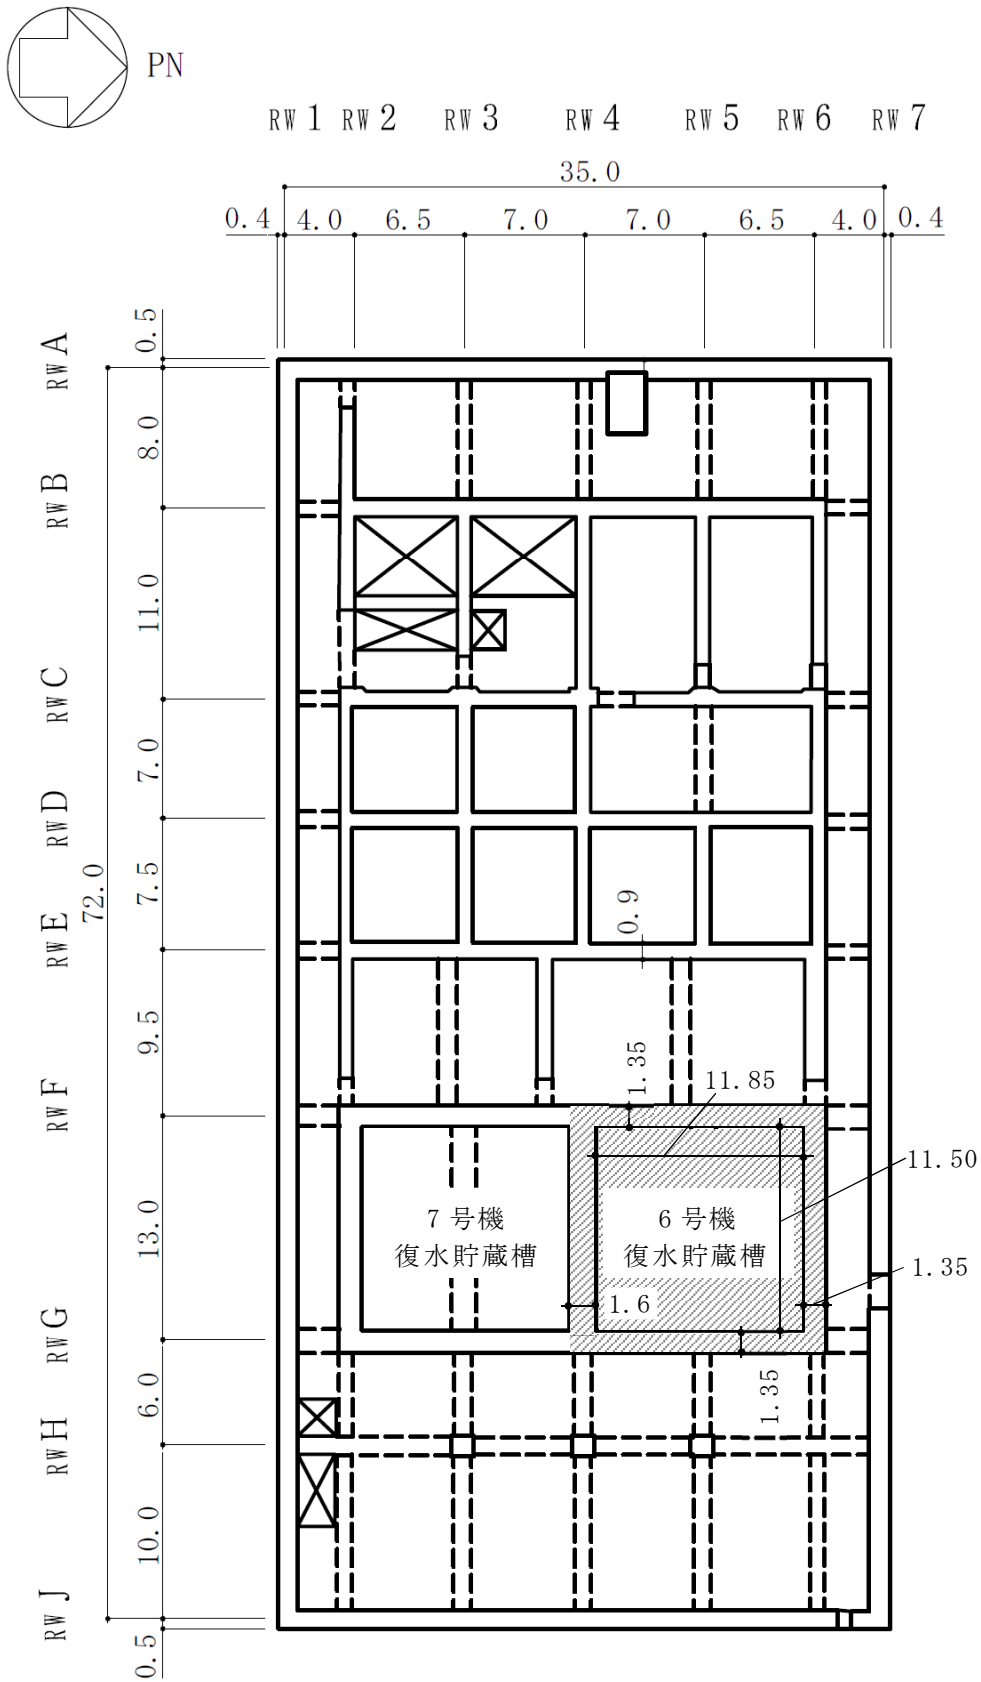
復水貯蔵槽を含む廃棄物処理建屋の概略平面図
